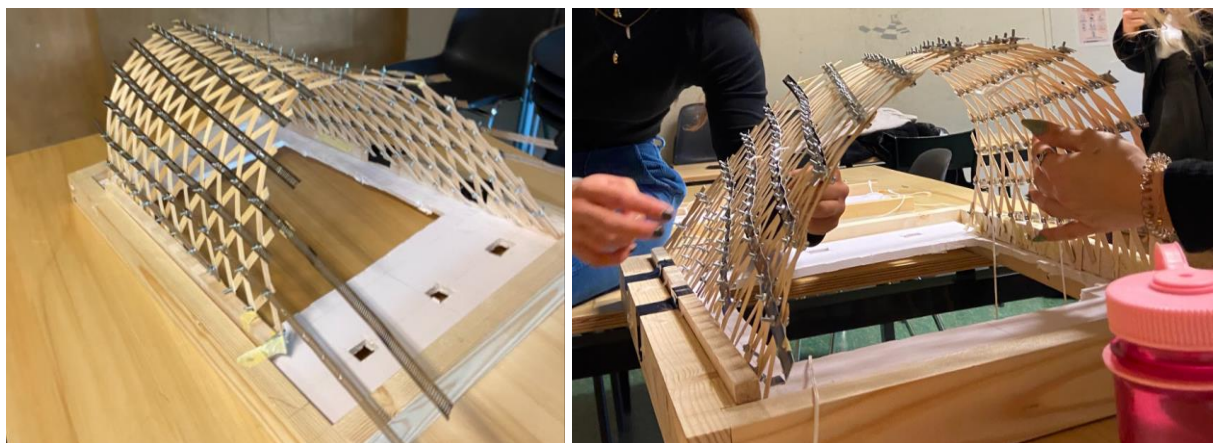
Essai de chargement sur maquette 1/10^{ème} du projet Elastica (simple lattage avec contreventements).
